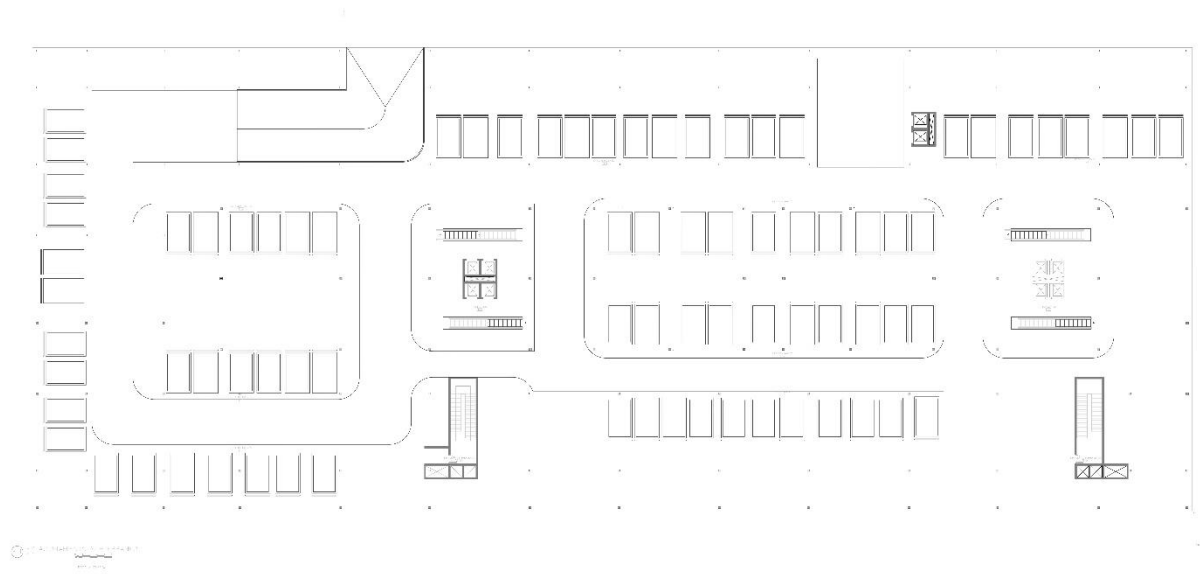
Planimetría Parqueadero. Fuente: Elaboración propia.
